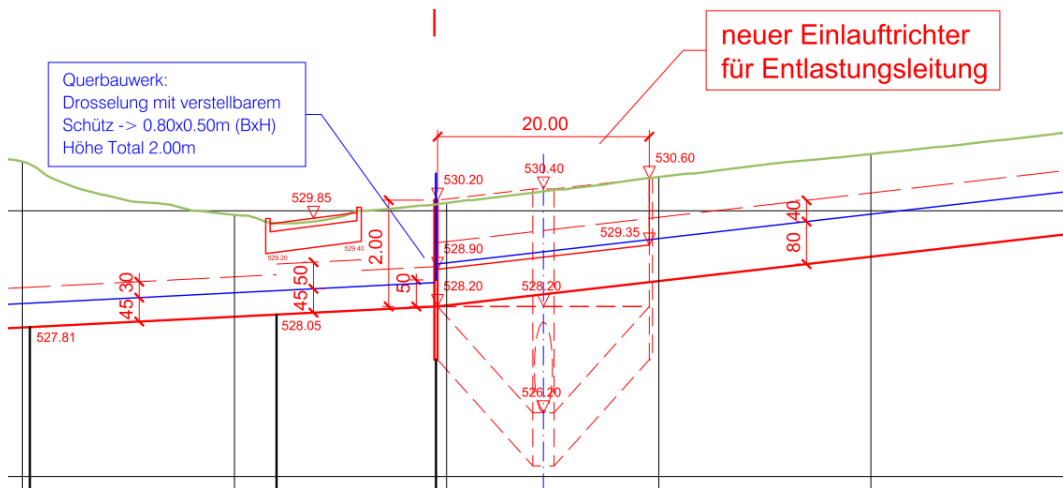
Längsschnitt durch Entlastungsbauwerk mit Überfallkante und dem Querbauwerk.
